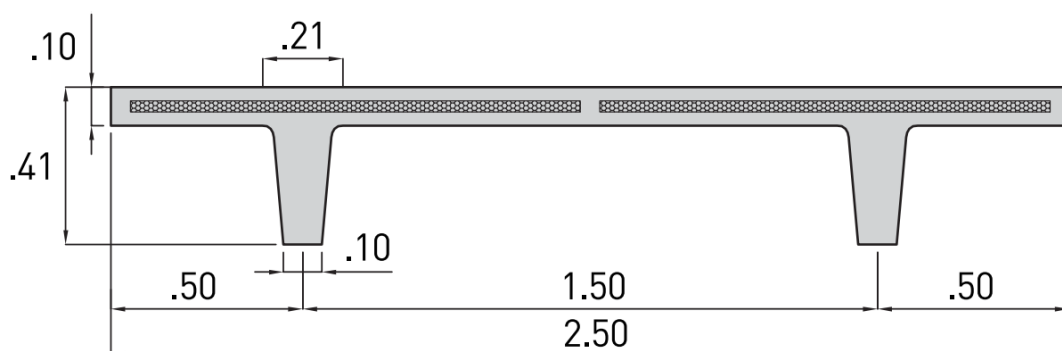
Diseño y dimensiones de un panel de cerramiento lateral con planchas de poliestireno expandido en su interior. Vista en sección transversal. Fuente: sitio web de la empresa Astori Estructuras S.A..
